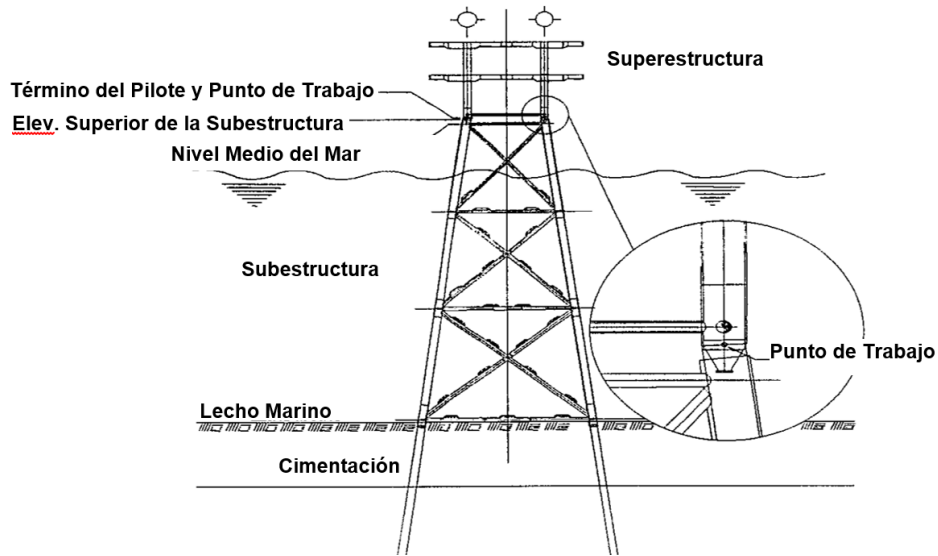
Esquema de estructuración de una plataforma tipo Jacket.
